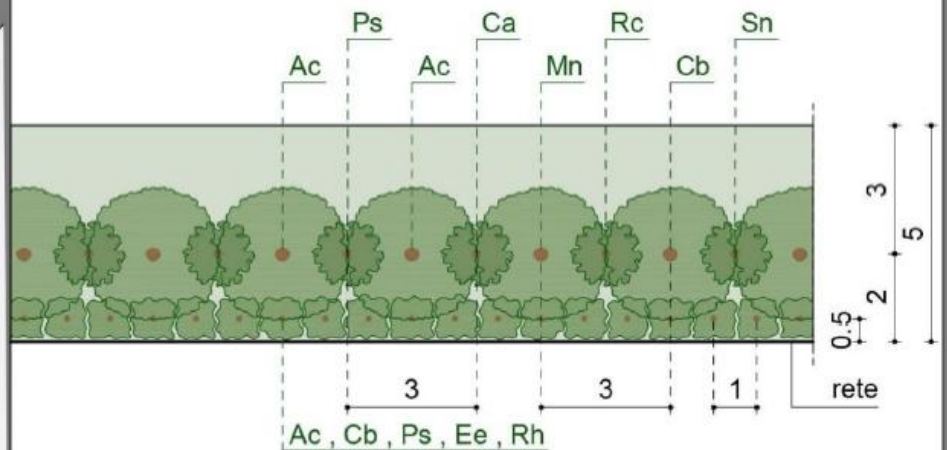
Schema d'impianto planimetrico fascia di mitigazione Sez. A'-A''
